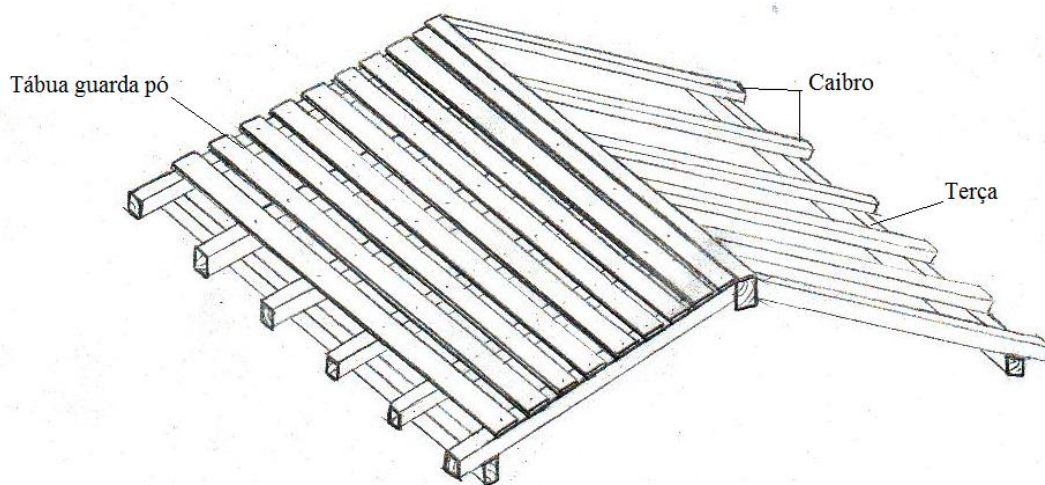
Estruturas em madeira de coberturas executadas em construções de adobe (Fonte: autor)
